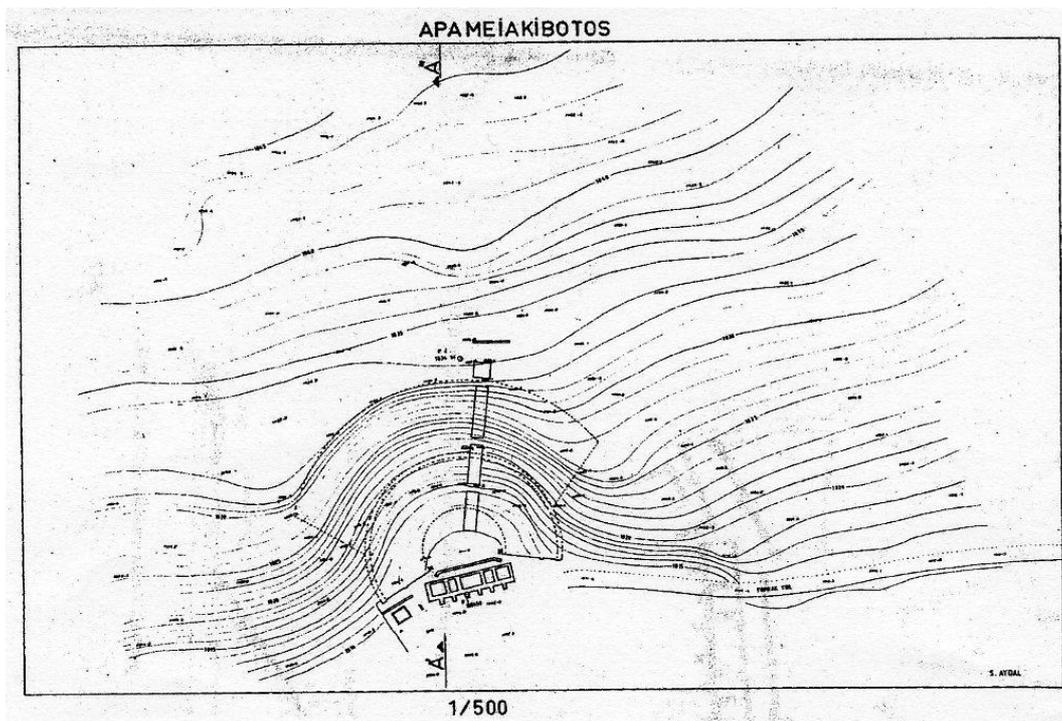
Kelainai, Theater (Situationsplan)/ Théâtre, plan général
